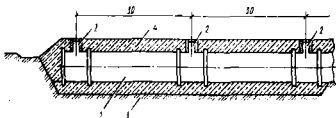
Продольный профиль оголовка рассеивающего выпуска: 1 — труба; 2 — выпуски оголовка; 3 — подготовка из щебня; 4 — каменная наброска
